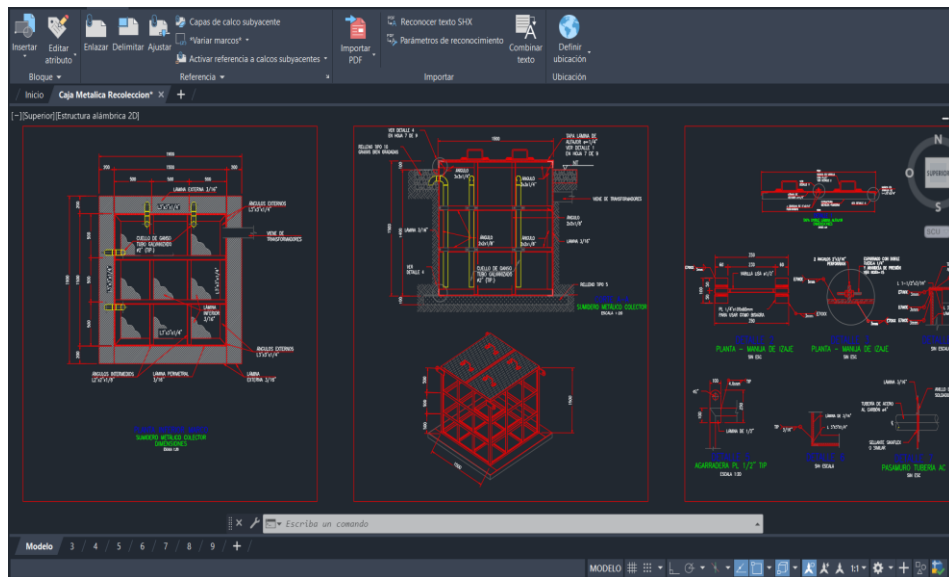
Plano digital enviado por la empresa ICC-ECOPETROL
